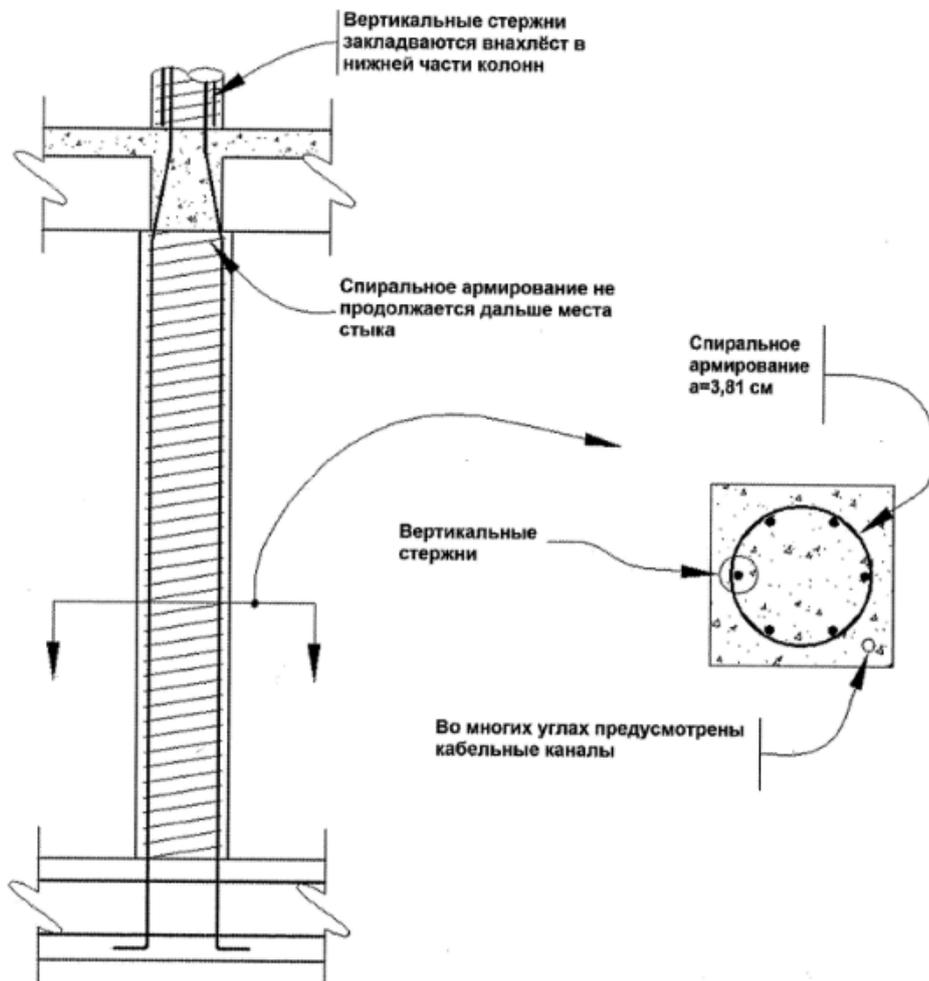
Железобетонная колонна наружного кольца здания Пентагона
